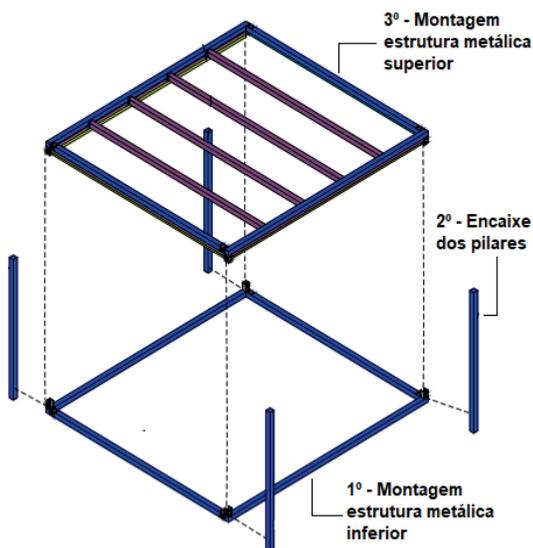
Sequência de montagem da estrutura metálica com encaixes
